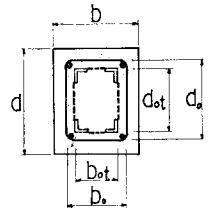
鉄骨鉄筋コンクリート部材における鉄筋および鉄骨位置
